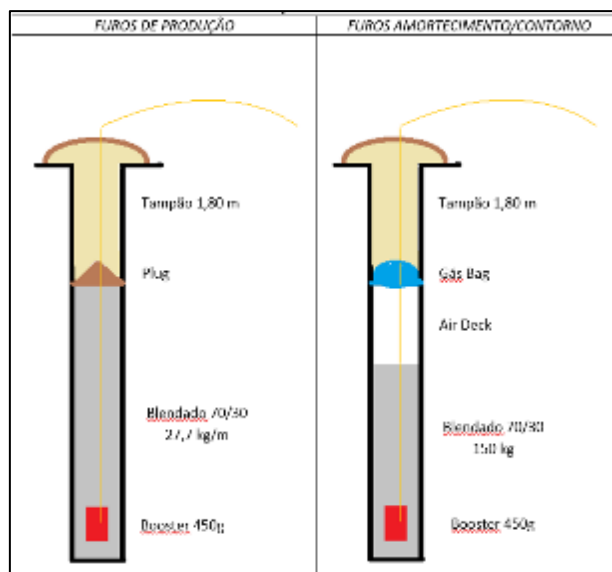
Desmorte utilizando a técnica *Smooth Blasting
